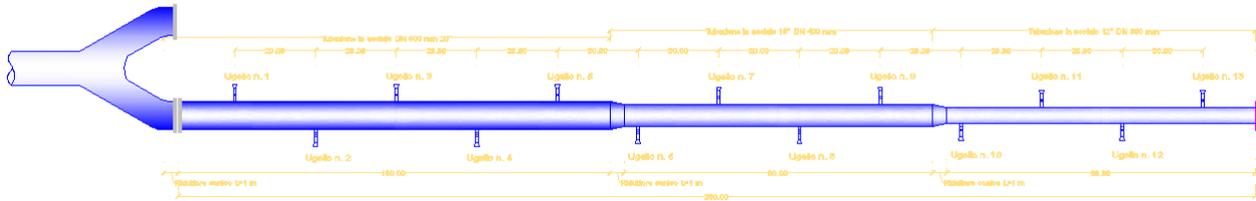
Planimetria condotta sottomarina e particolare innesto.
